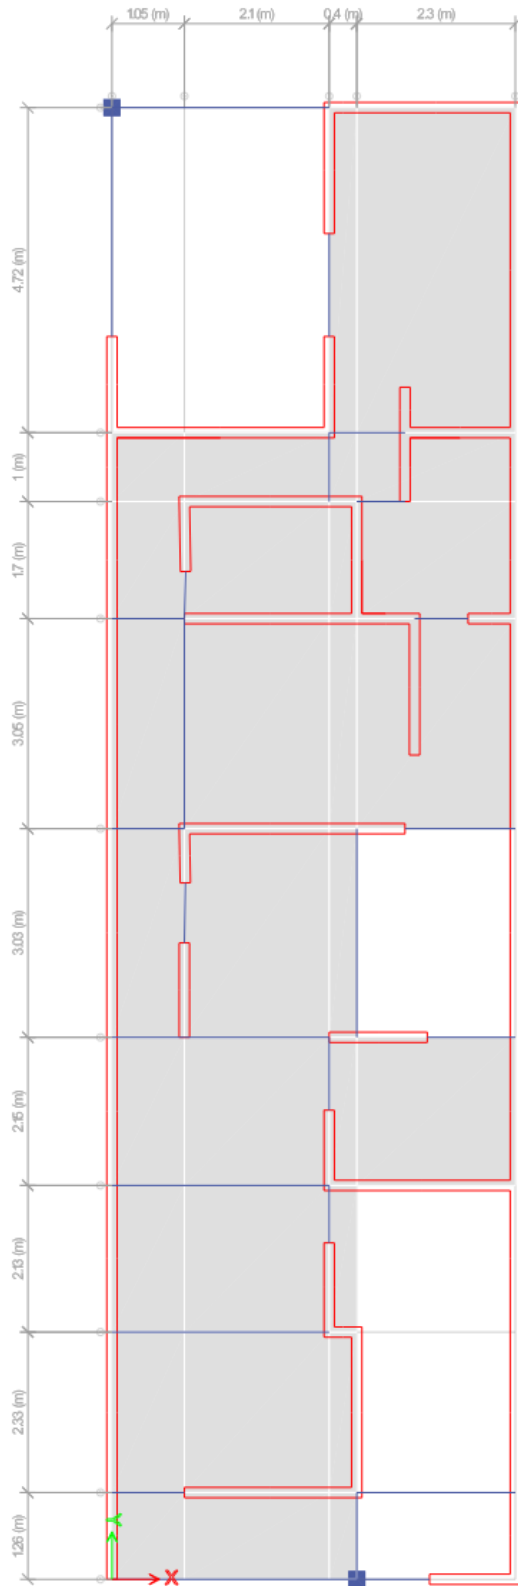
Modelamiento en planta, estructura de albañilería confinada
